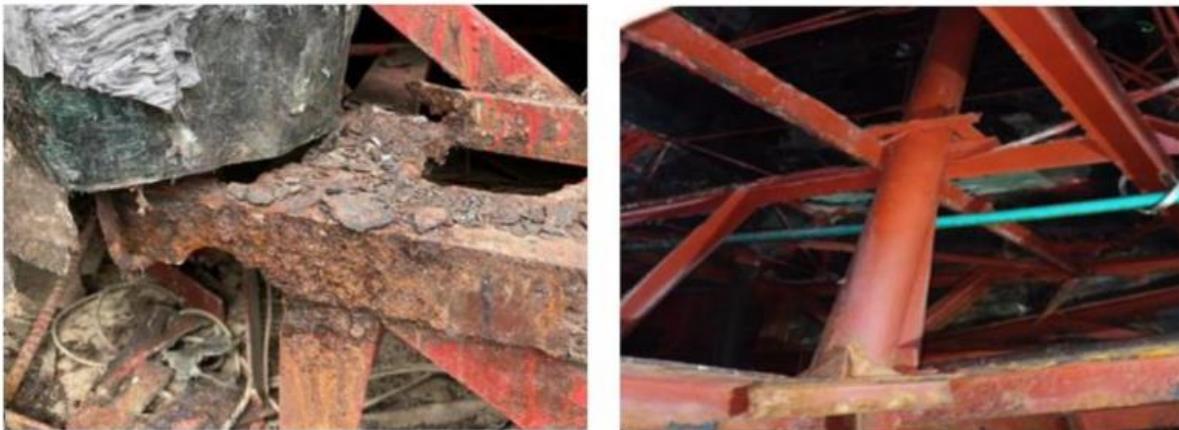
Algunas zonas de la estructura con deterioro por corrosión.
